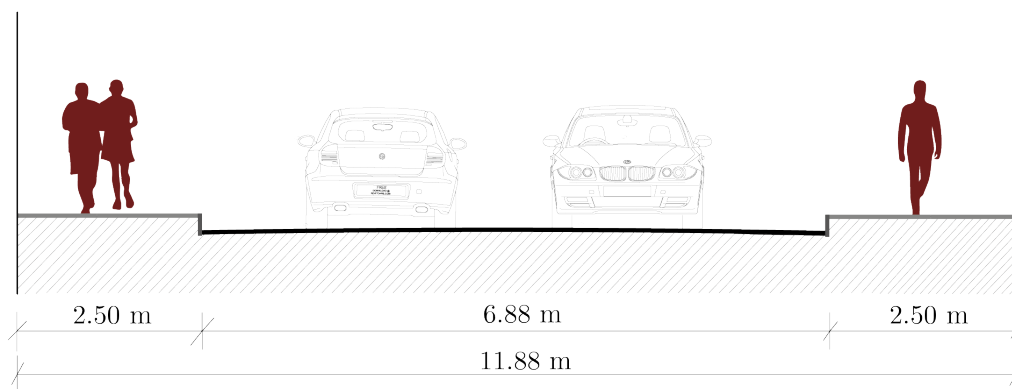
Sección vial de la calle: Cam. Nonguén. Elaboración: Propia.
